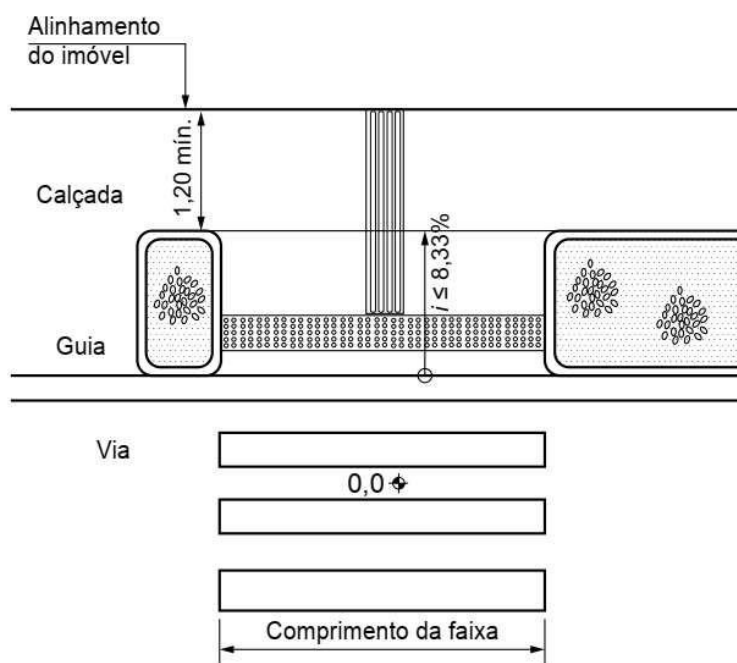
Detalhe rebaixamento de calçada (Fonte: NBR 9050/2021).
